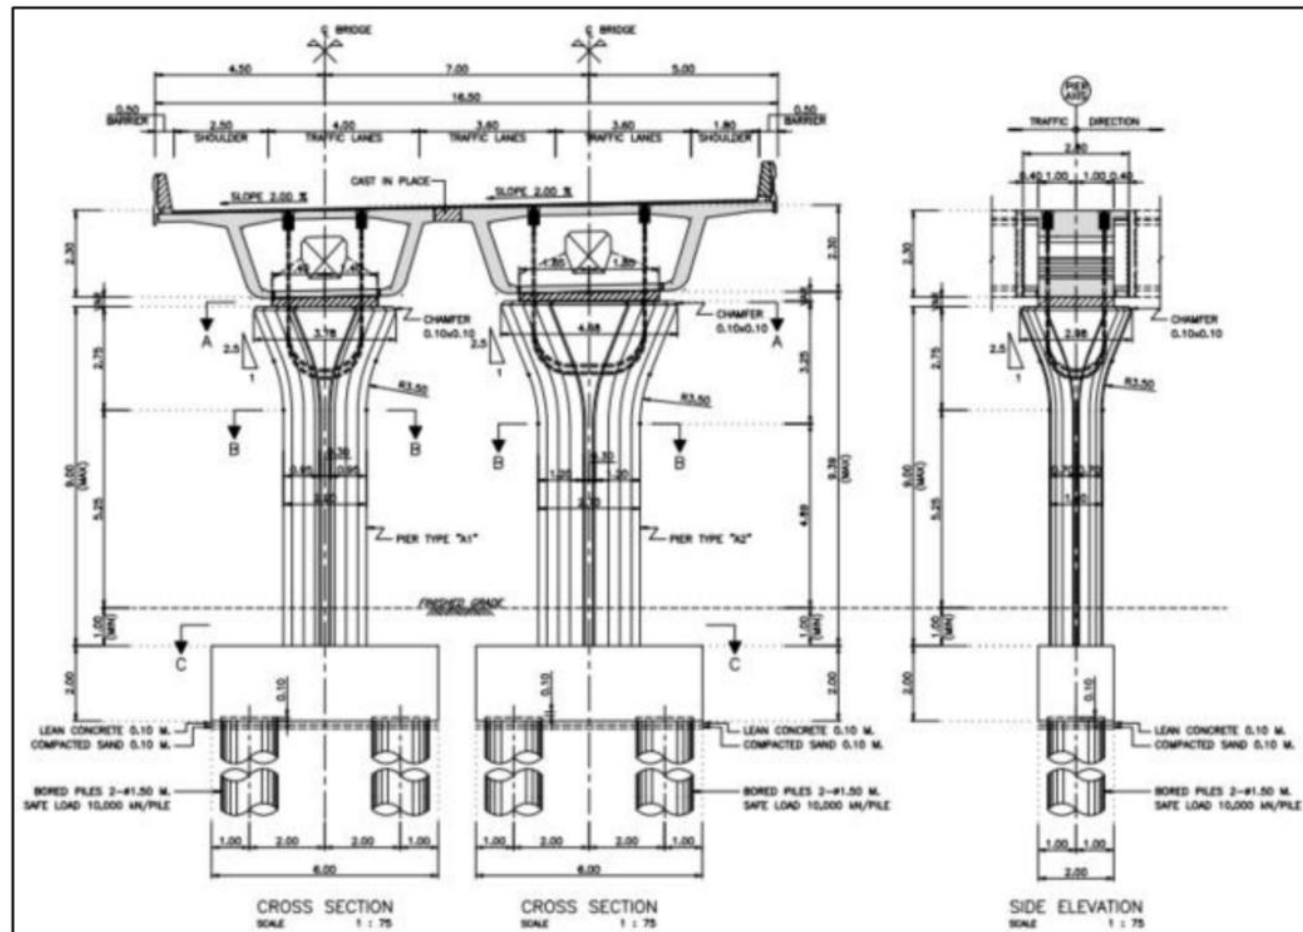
ตัวอย่าง Superstructure สะพานคอนกรีตอัดแรงรูปกล่องใช้ชิ้นส่วนหล่อสำเร็จ (Pre-cast Segmental Concrete Box Girder) รูปแบบความกว้าง Box 9.0 เมตร
